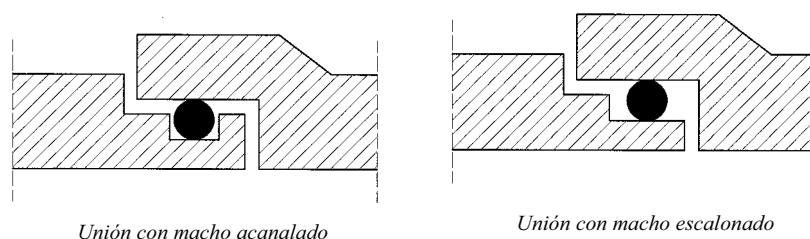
Uniones flexibles con extremos en enchufe y campana en los tubos de hormigón
